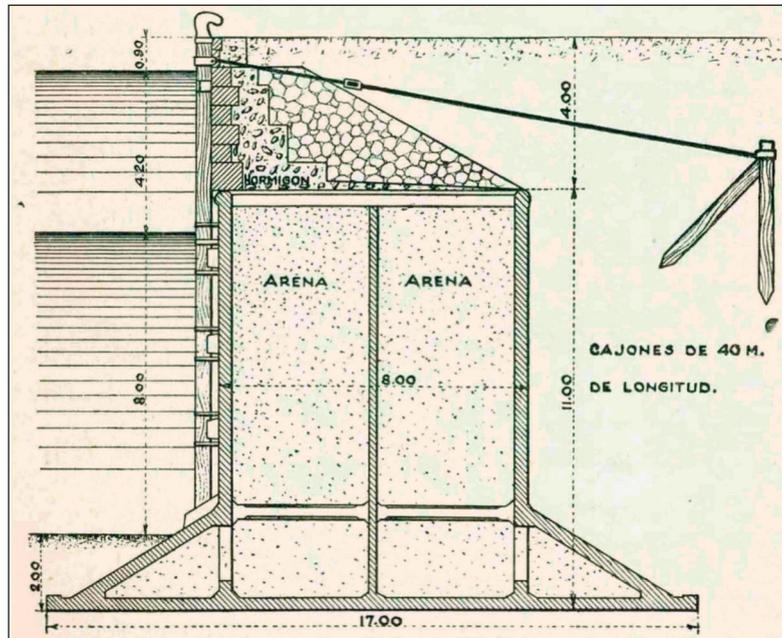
Sección de un cajón de hormigón del Puerto de Huelva con el relleno de arena y el sellado con solera de hormigón (Ribera 1930:242).
